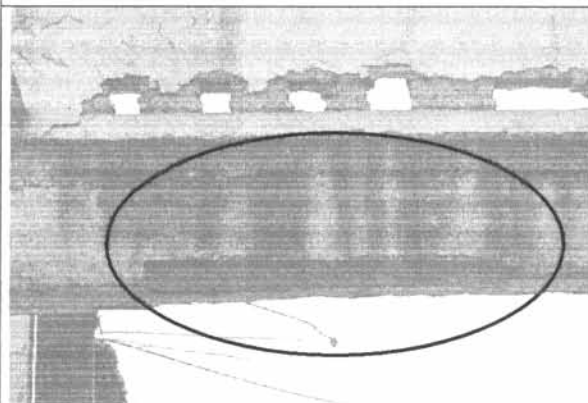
Corrosión del acero de refuerzo en vigas.
